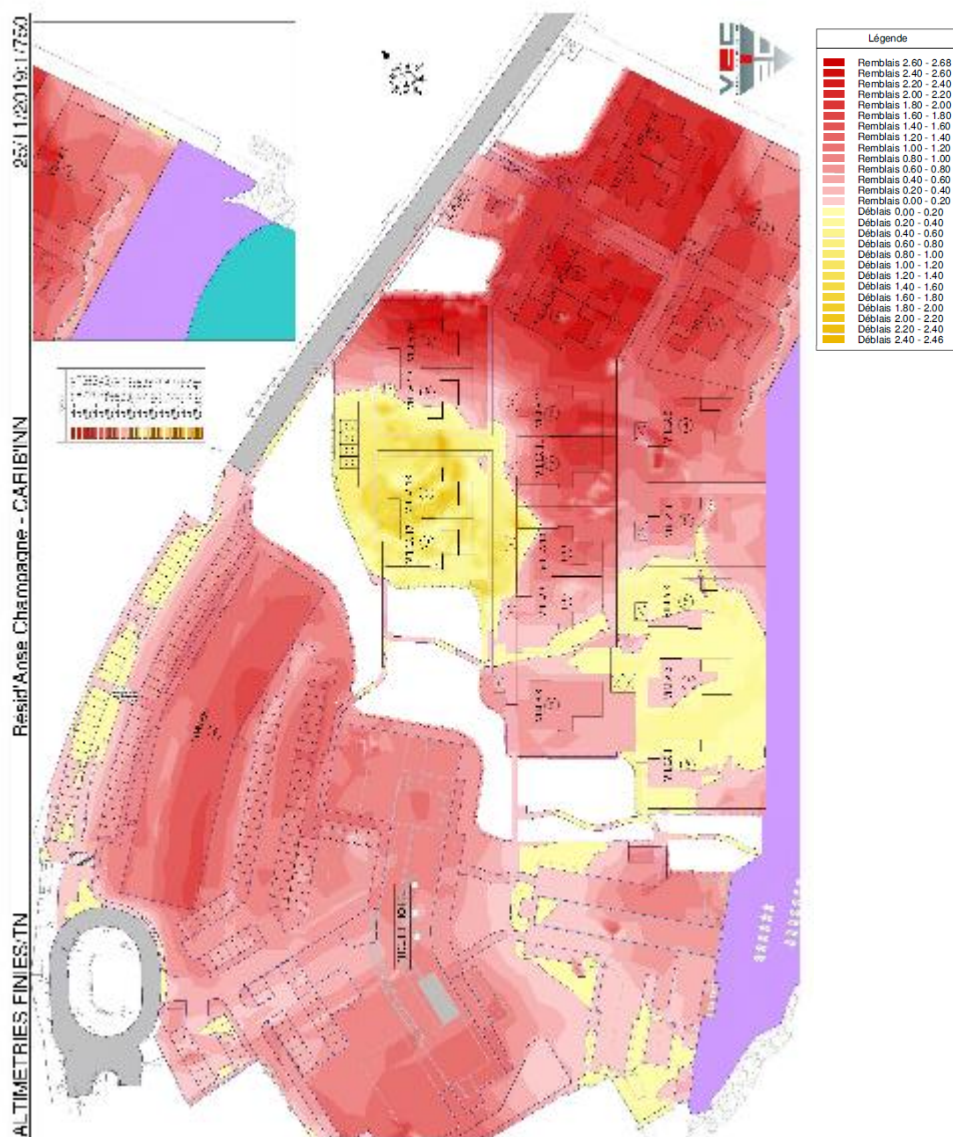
Plan de mouvement de terres prévu sur la zone de projet
